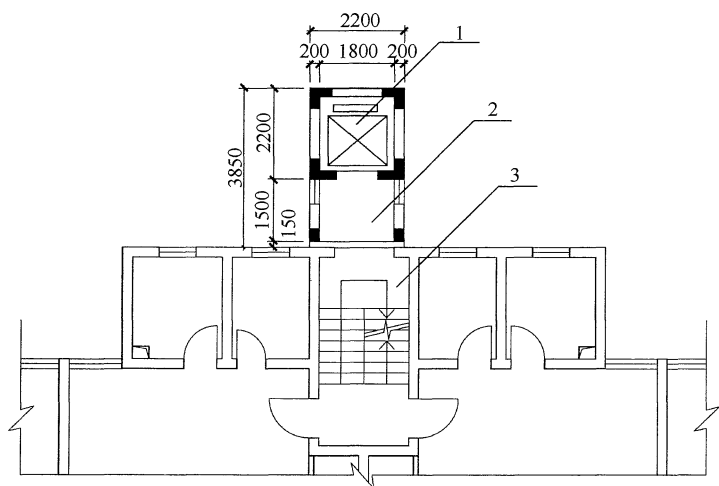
人流错半层入户电梯布置示意图 (标注单位: mm)
